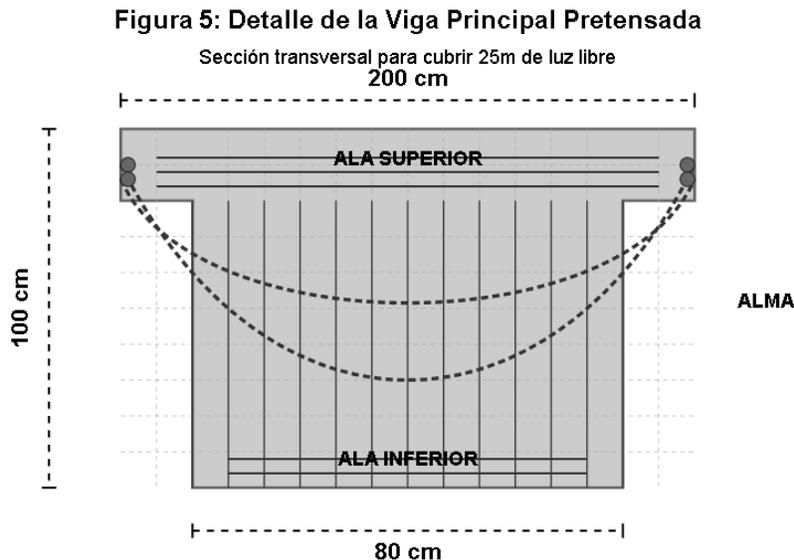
Detalle técnico de la sección transversal de la viga principal de hormigón pretensado. La viga tiene una altura total de 100 cm, un ancho superior de 200 cm y un ancho inferior de 80 cm. Se muestran los tendones de pretensado (líneas punteadas) que siguen una trayectoria parabólica para contrarrestar los momentos flectores. También se observa la armadura pasiva complementaria. Esta configuración permitía cubrir los 25 metros de luz libre sin columnas intermedias, característica esencial para el uso original como cine, pero insuficiente para soportar la sobrecarga concentrada añadida posteriormente.
